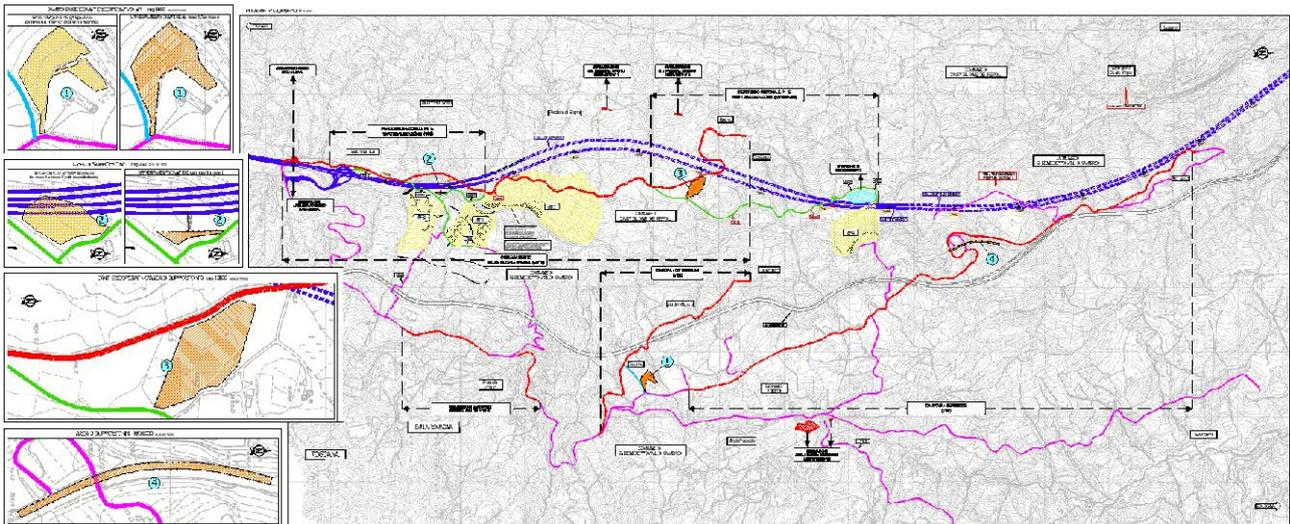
Planimetria opere di cantierizzazione dei lotti 6/7 utilizzate per la realizzazione delle opere
